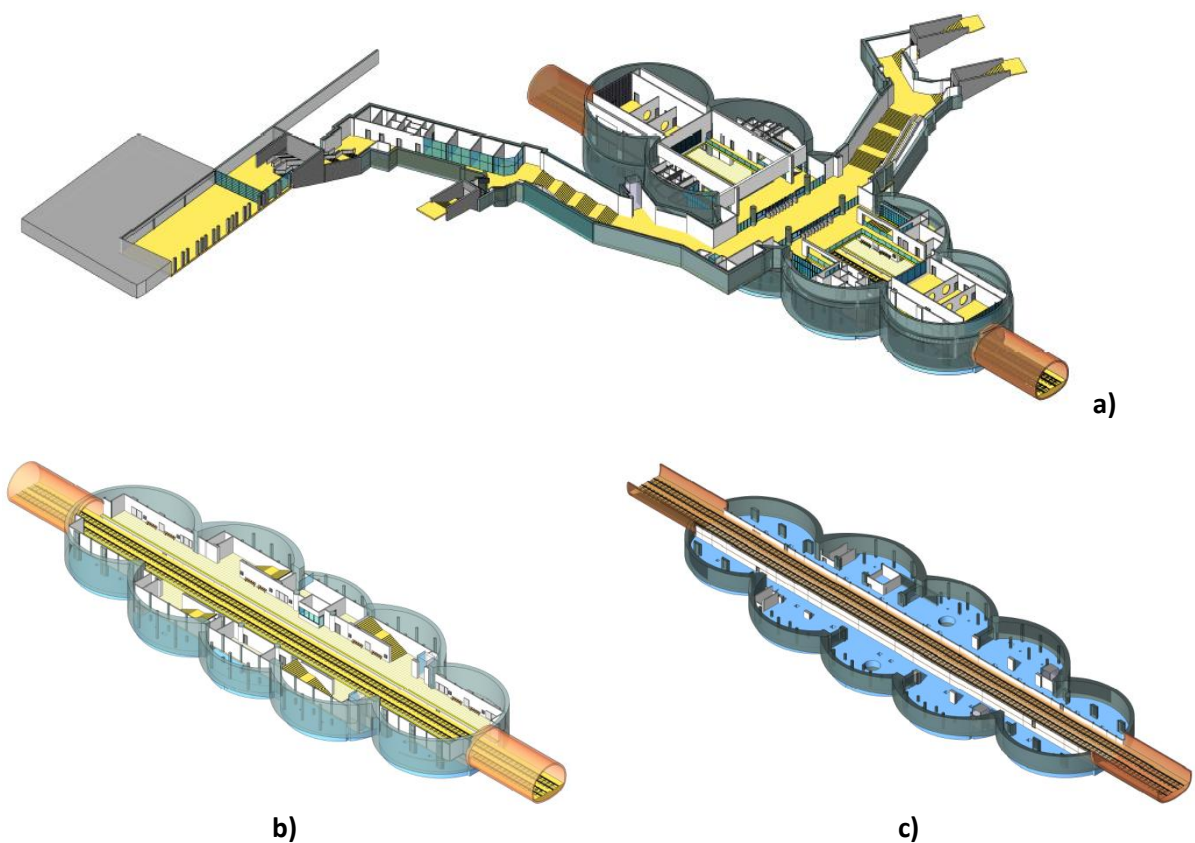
Esquema tridimensional da estação: a) Geral; b) Planta do cais; c) Planta do sub-cais.
